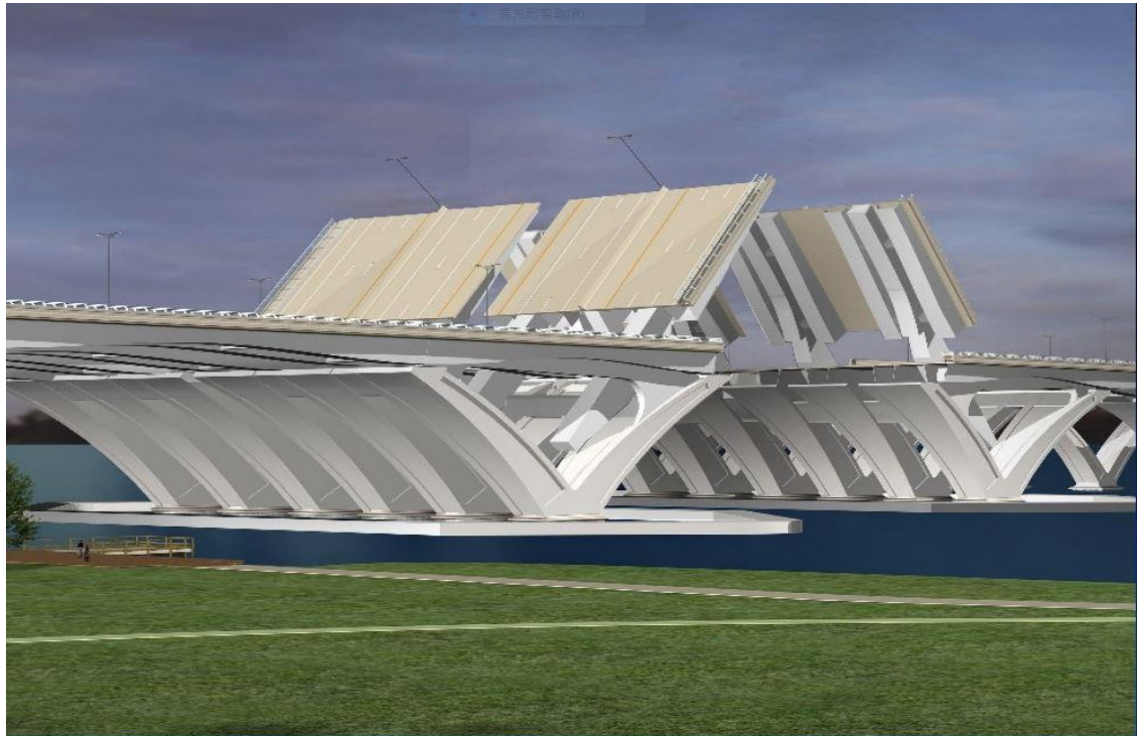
45 Woodrow Wilson Memorial Bridge 活動開合跨徑開啟示意
